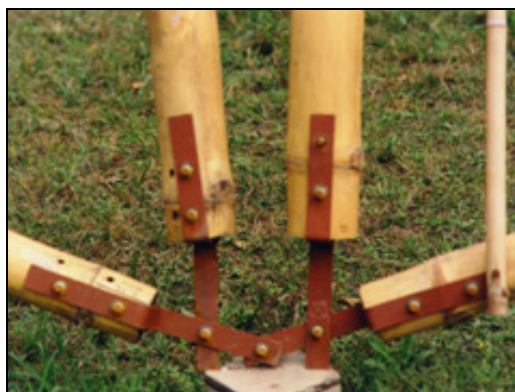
Chapas de ligação metálica de Mark Mortimer
